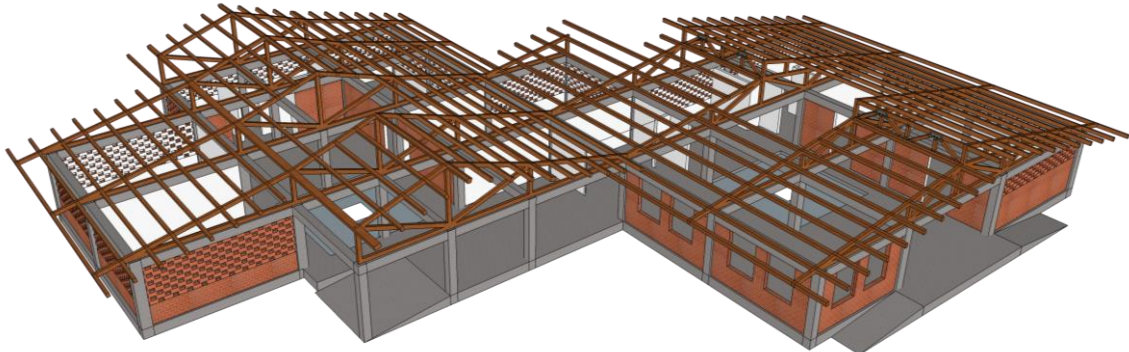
Sistema de mampostería confinada y estructura de hormigón armado.
